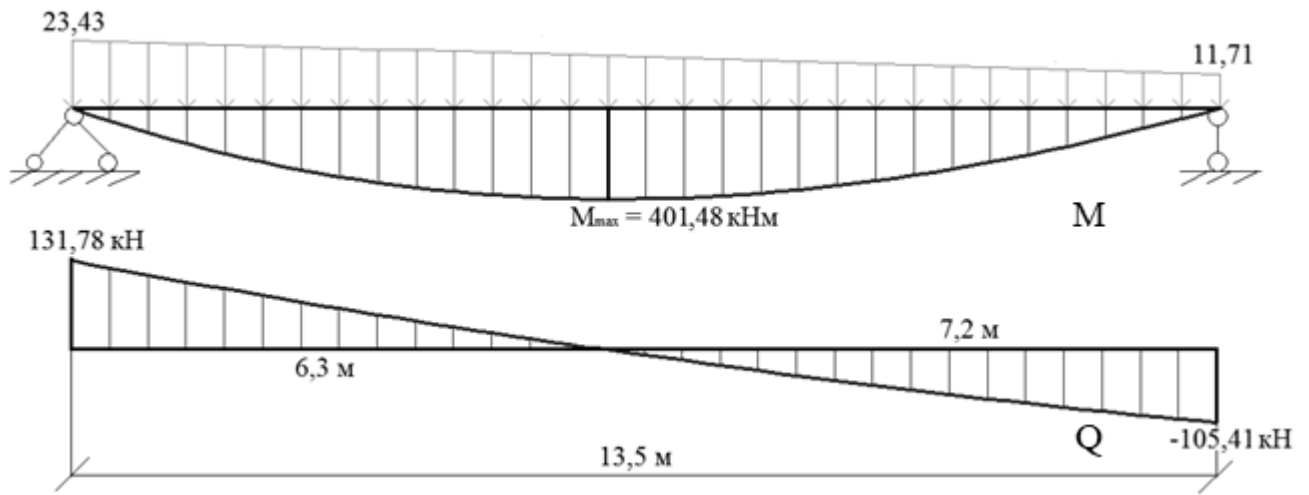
Расчетная схема плиты и эпюры усилий
